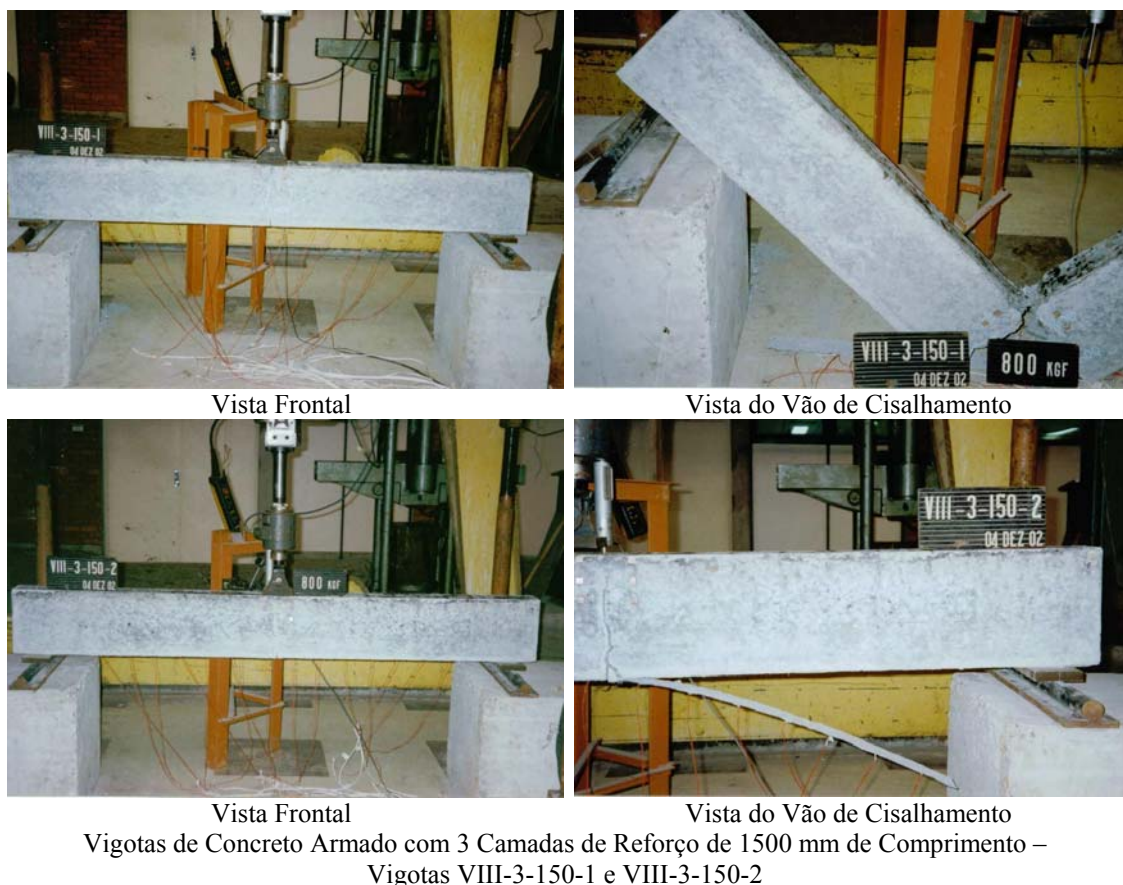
Fissuração e Aspecto Pós-Ruptura das Vigotas Reforçadas de Concreto Armado (Continuação)
